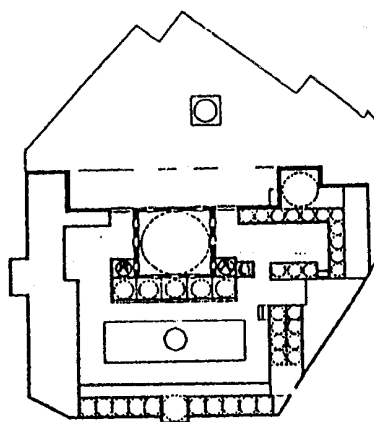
مسقط أفقي لجامع قوجه سنان باشا في بورسہ يني شهر (عن : Otuken)
